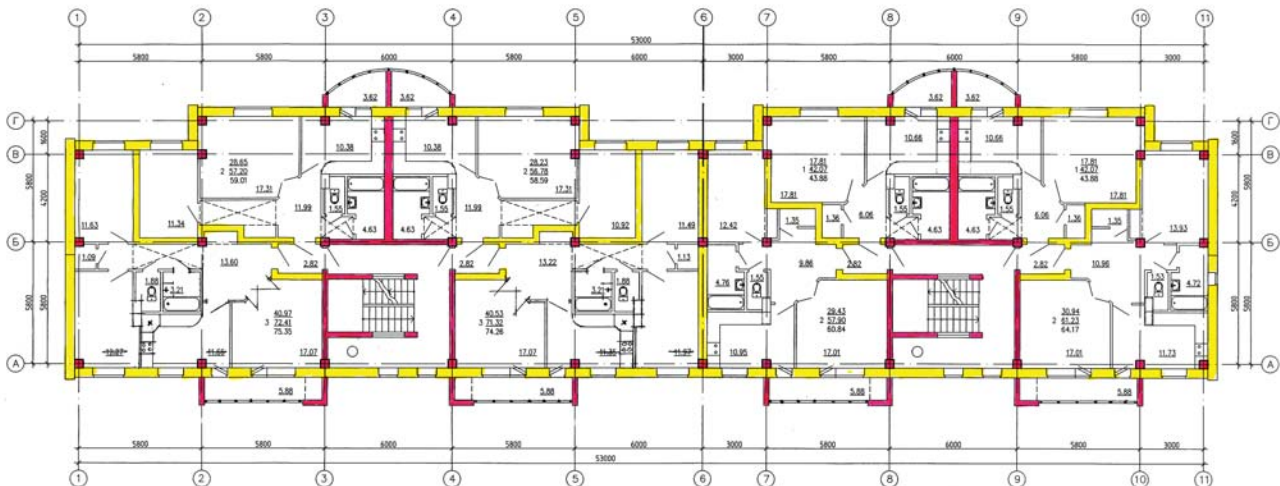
Экспериментальный пятиэтажный 40-квартирный жилой дом на основе сборного каркаса с наружными стенными панелями из газосиликата в г. Сморгонь
